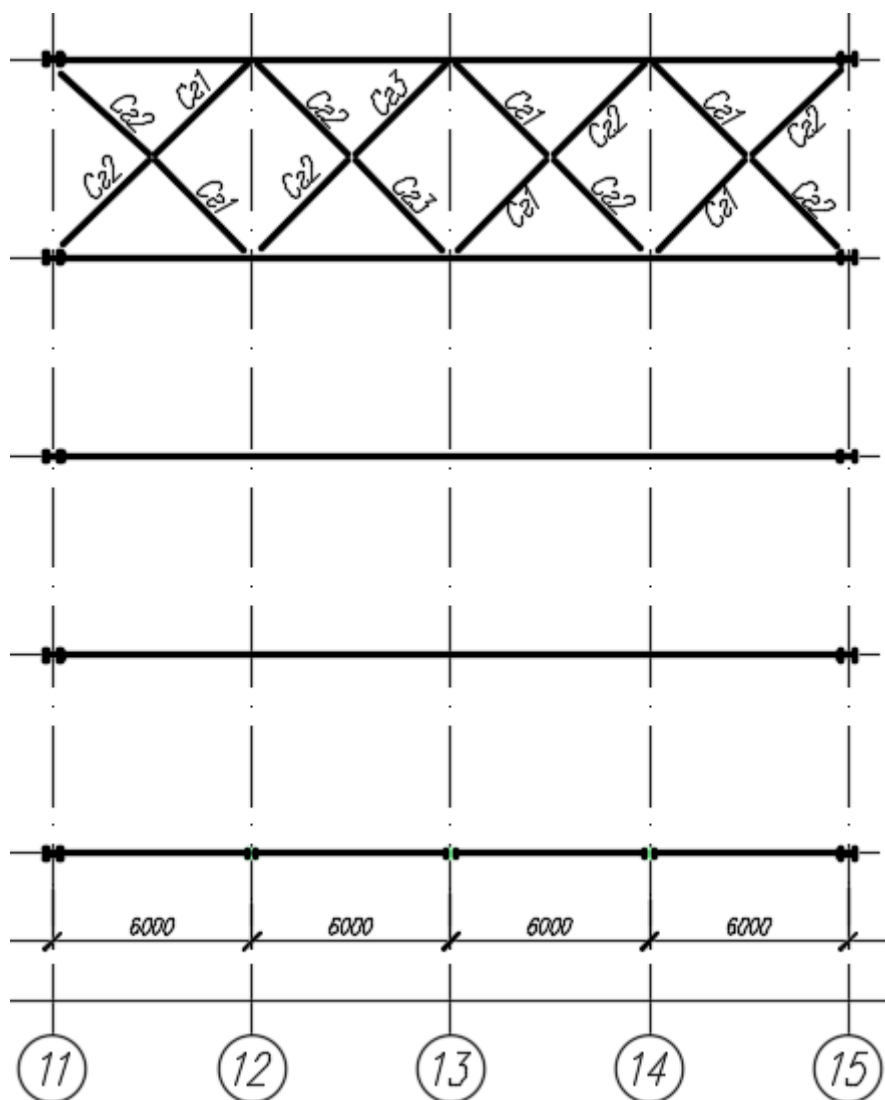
Пример решения связей в покрытиях по нижним поясам стальных стропильных ферм: 1 – распорки, 2 – растяжки, 3 – раскосы, 4 – вертикальные связи, 5 – стропильные фермы, 6 – связевые фермы
